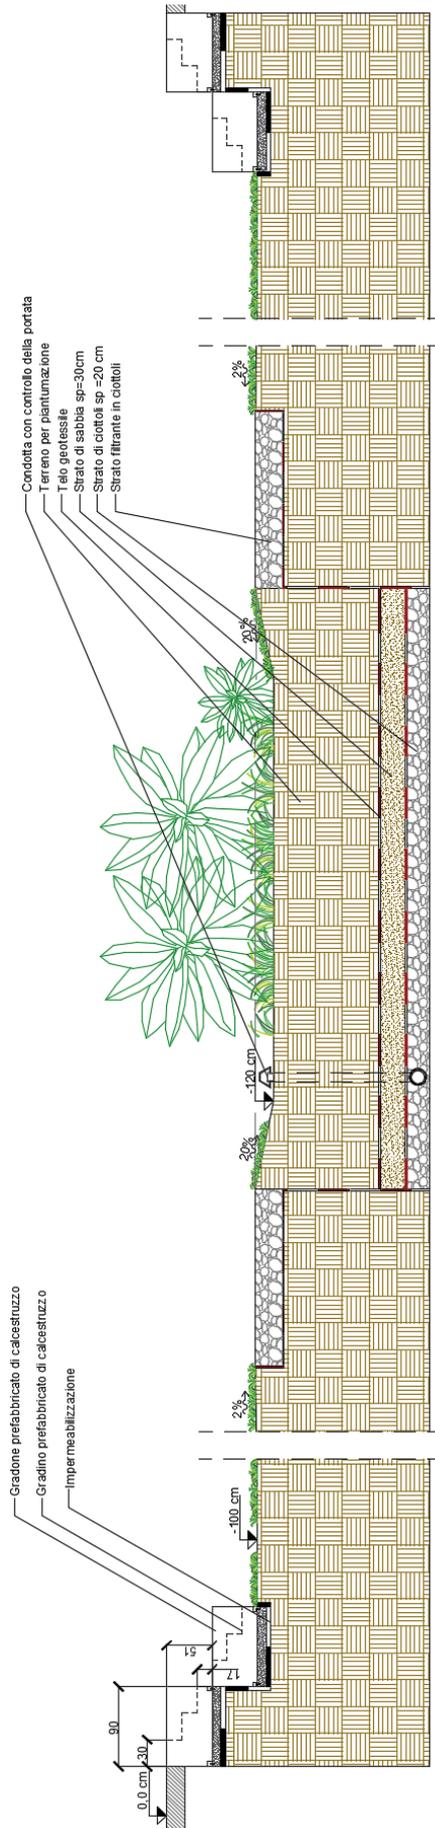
Sezione trasversale bacino 2 (Realizzato con AutoCAD 2023)
